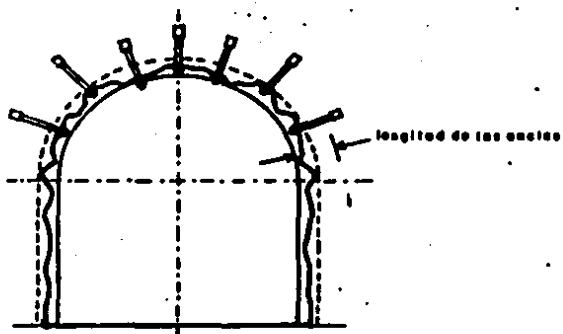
Refuerzo de una excavación que se autoporta.
